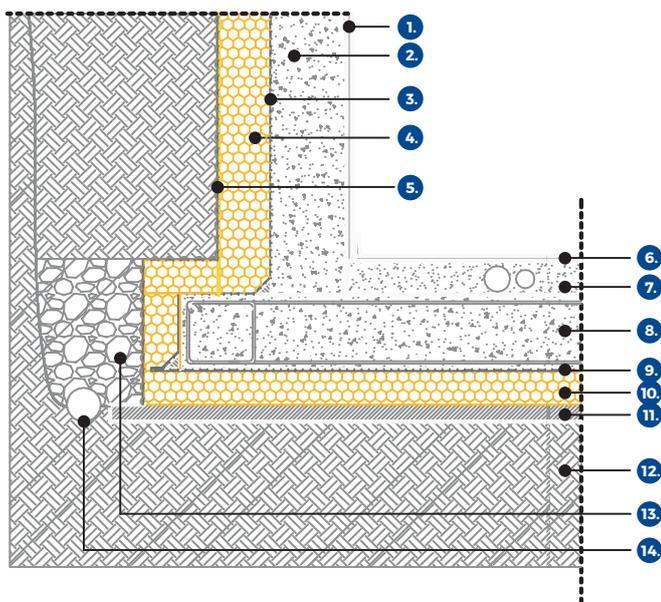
Isolamento sotto platea di fondazione con pannello isolante (nuova costruzione): 1) Intonaco, 2) Parete controterra, 3) Impermeabilizzazione, 4) XPS/Vetro cellulare, 5) Membrana protettiva e drenante con TNT, 6) Pavimentazione, 7) Massetto alleggerito, 8) Platea di fondazione, 9) Geotessuto, 10) XPS/Vetro cellulare, 11) Magrone, 12) Terreno, 13) Ricoprimento drenante, 14) Tubo di raccolta acque.
